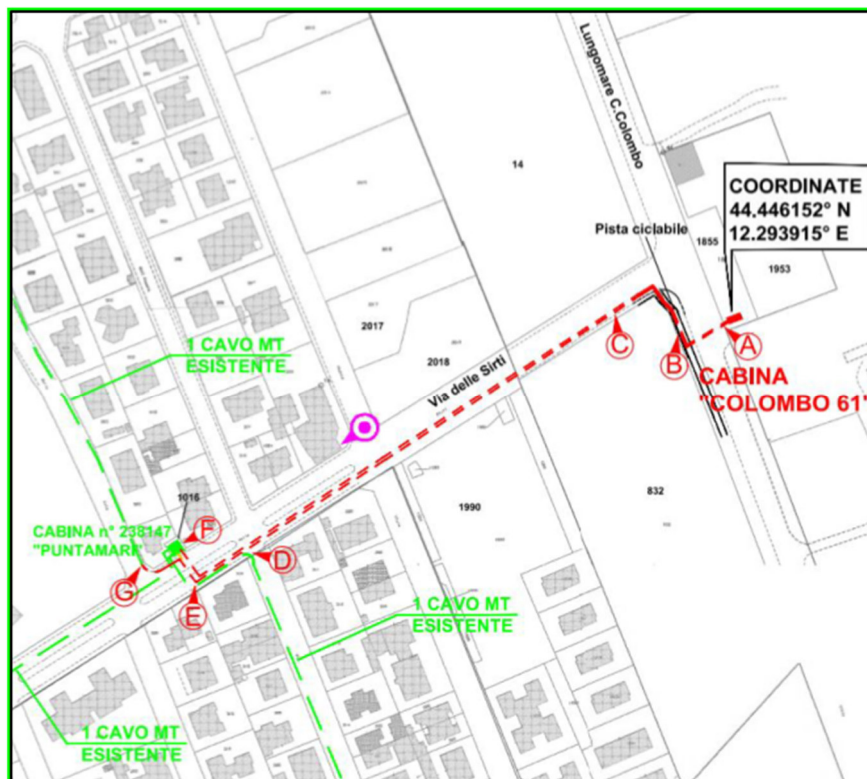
Tracciato cavidotto in progetto da parte di E-distribuzione
